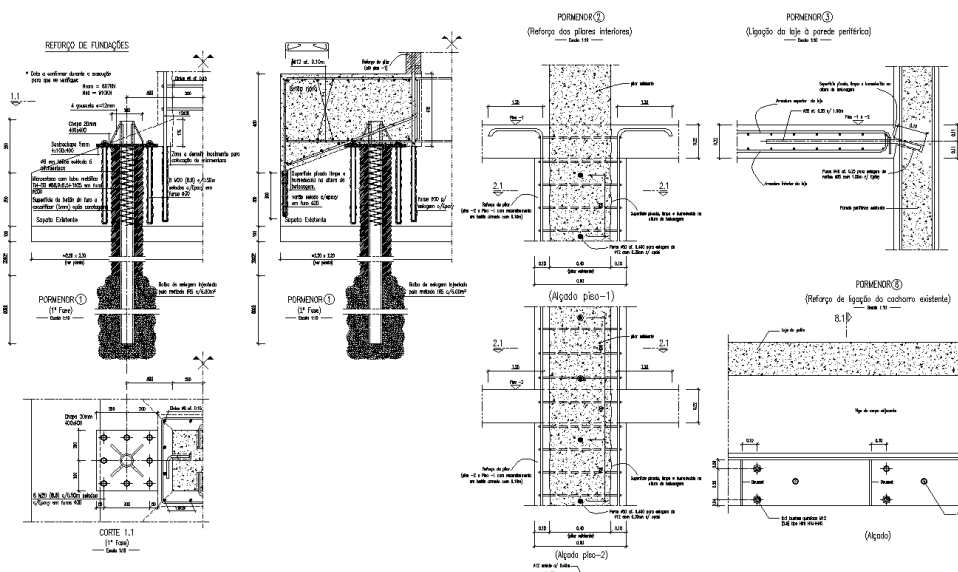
Pormenores do Reforço de Fundações e do Encamisamento dos pilares
